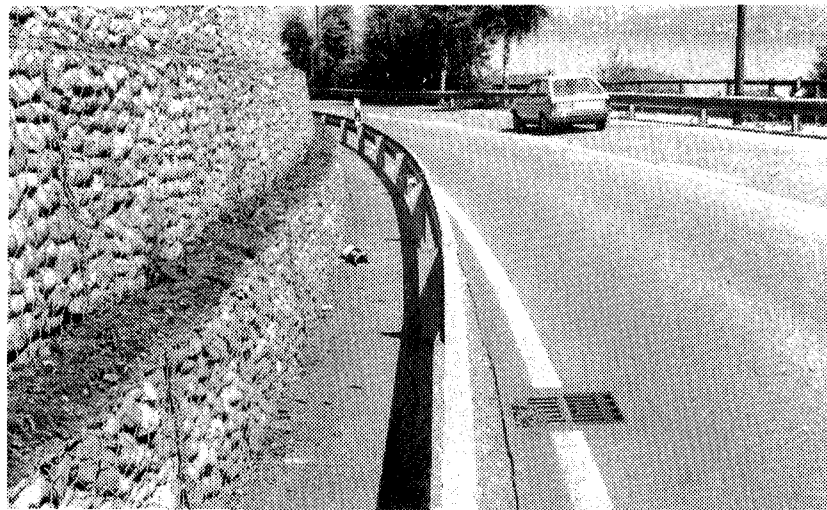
, Leitschranke vor einer Böschungssicherung mit Steinkörben - gute Anordnung mit ausreichendem Deformationsraum
